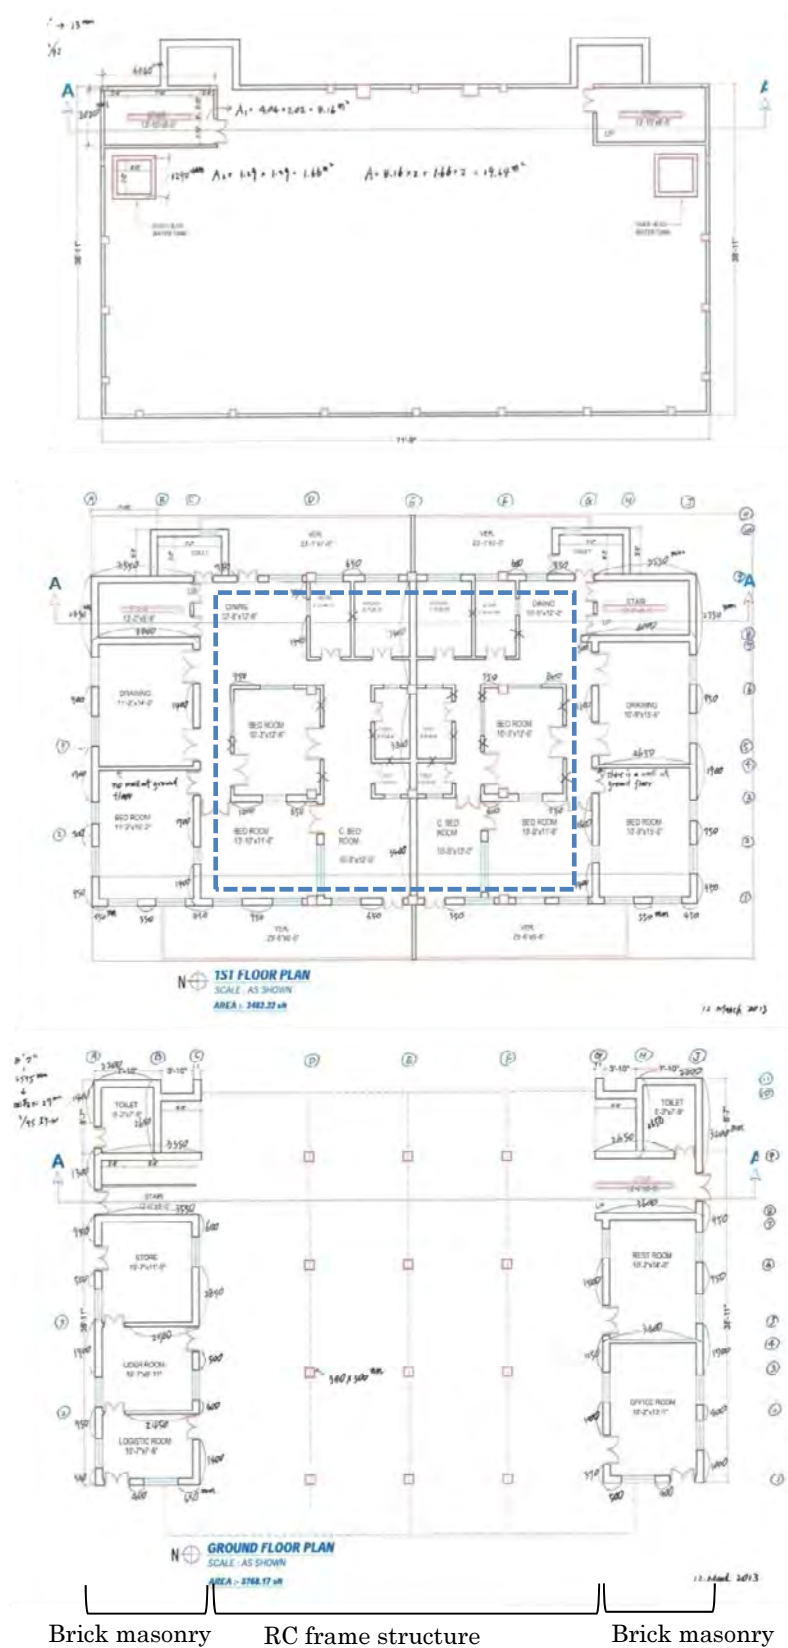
建物各階平面図（レンガ壁厚は、外壁 250mm、内壁 125mm）
